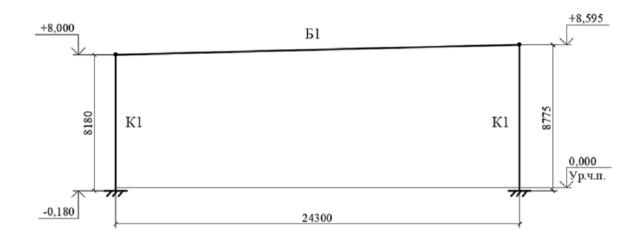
Расчётная схема поперечной рамы каркаса проектируемого здания
